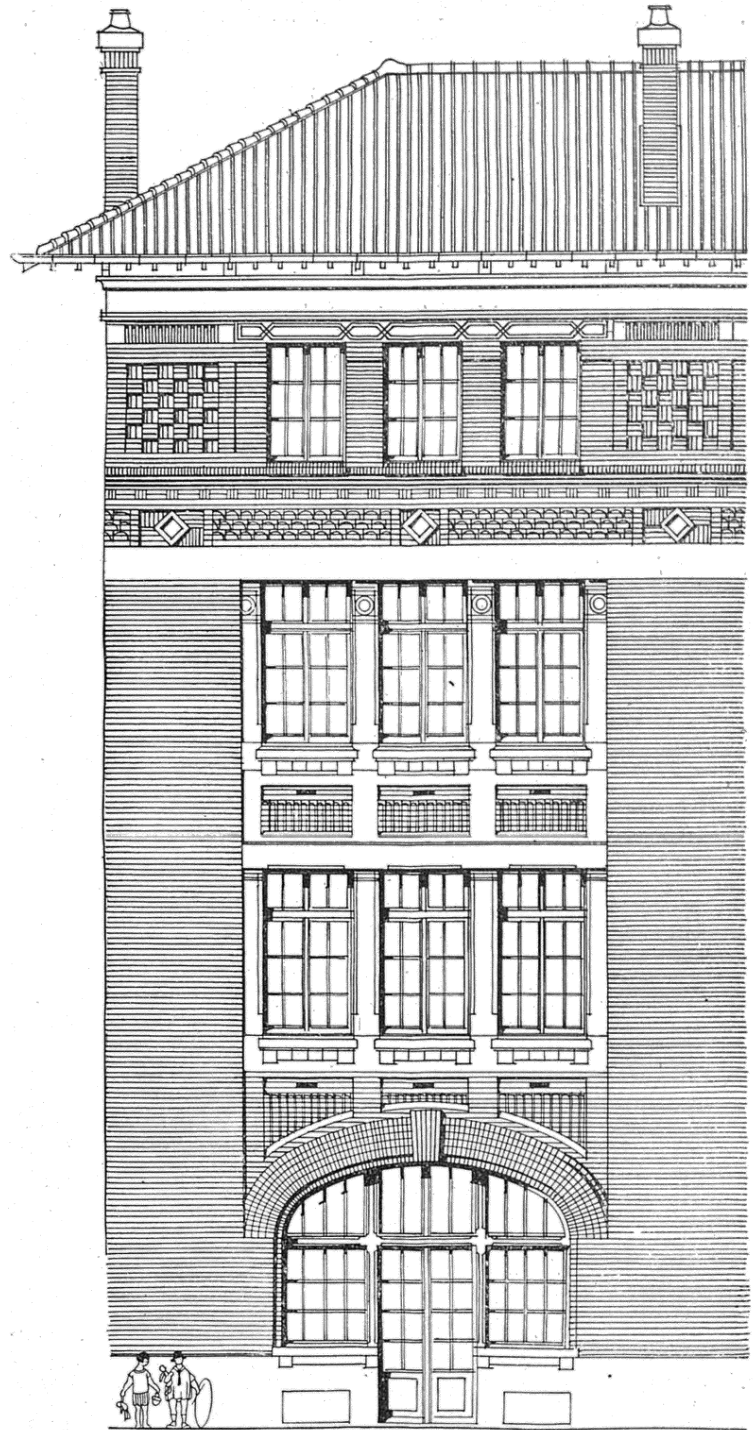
« Groupe scolaire rue Madame. Façade géométrale : R. Bouvard, Architecte » GOISSAUD, Antony. Le groupe scolaire de la rue Madame. *La construction moderne*, juillet 1926, 41<sup>ème</sup> année, n°41, p. 485.
